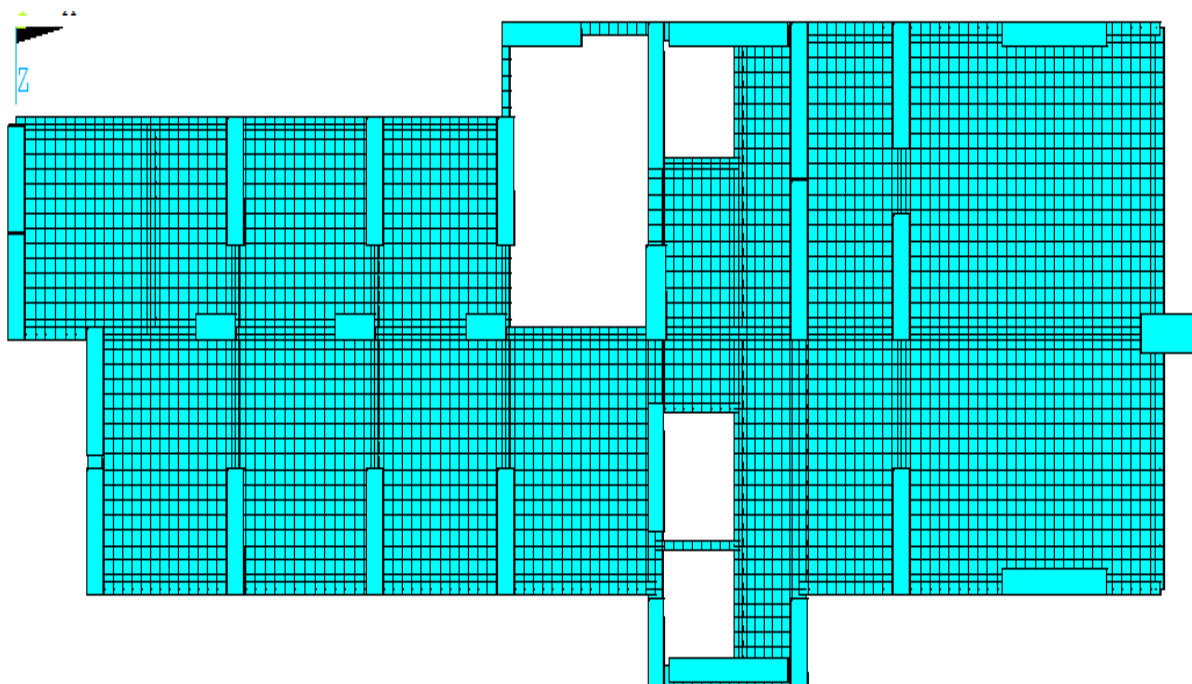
Pavimento tipo em elementos finitos (H = 140 m).
